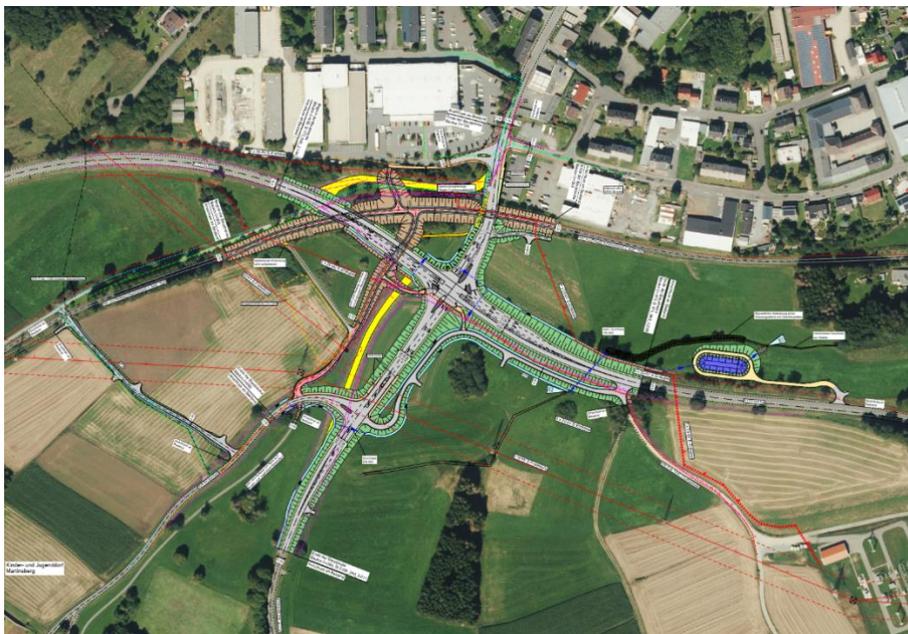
Ausführungsvariante Kreuzung mit Lichtsignalanlage
